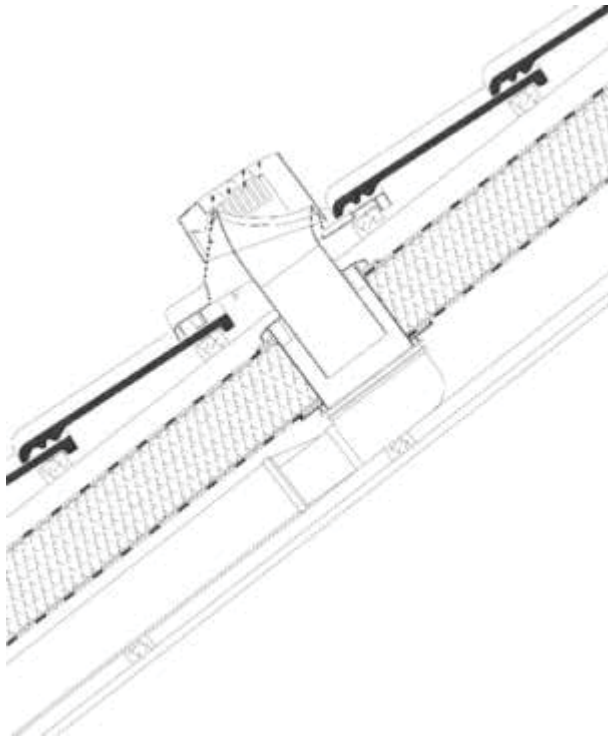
Mündung der Lüftungsleitung über Dach mit offenem Endrohr
